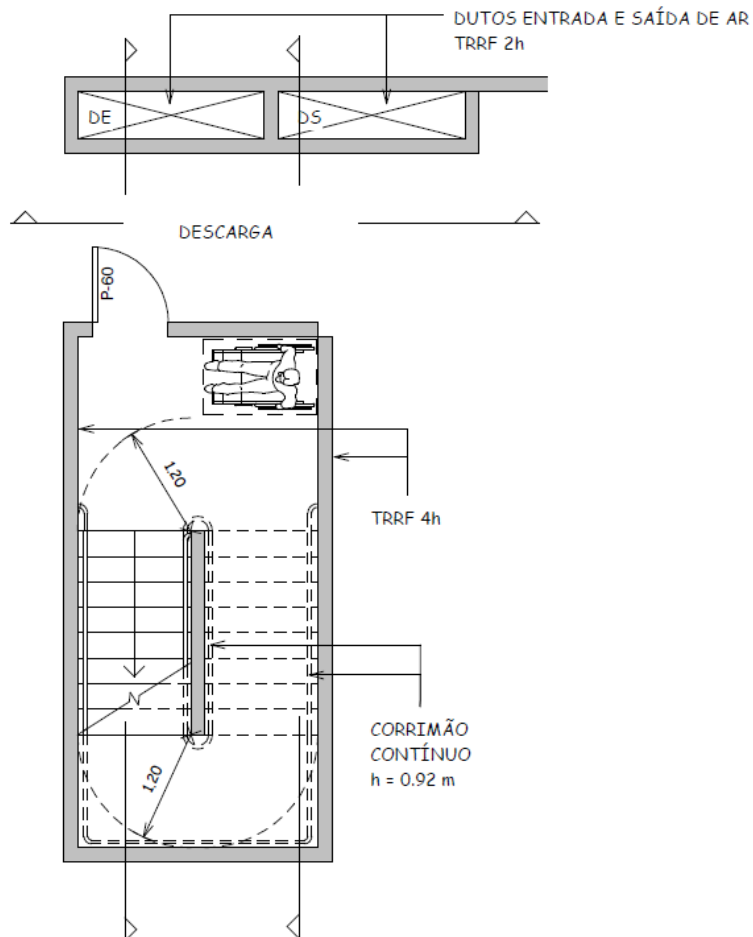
A - Escada à prova de fumaça - térreo (planta baixa).
